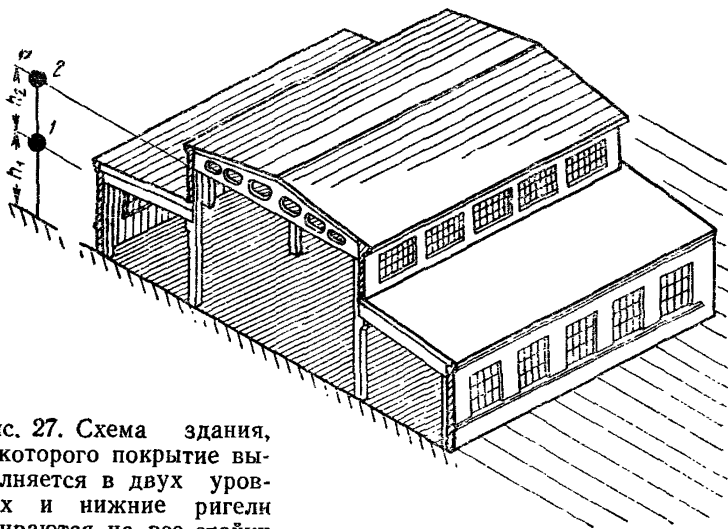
Схема здания, у которого покрытие выполняется в двух уровнях и нижние ригели опираются на все стойки
